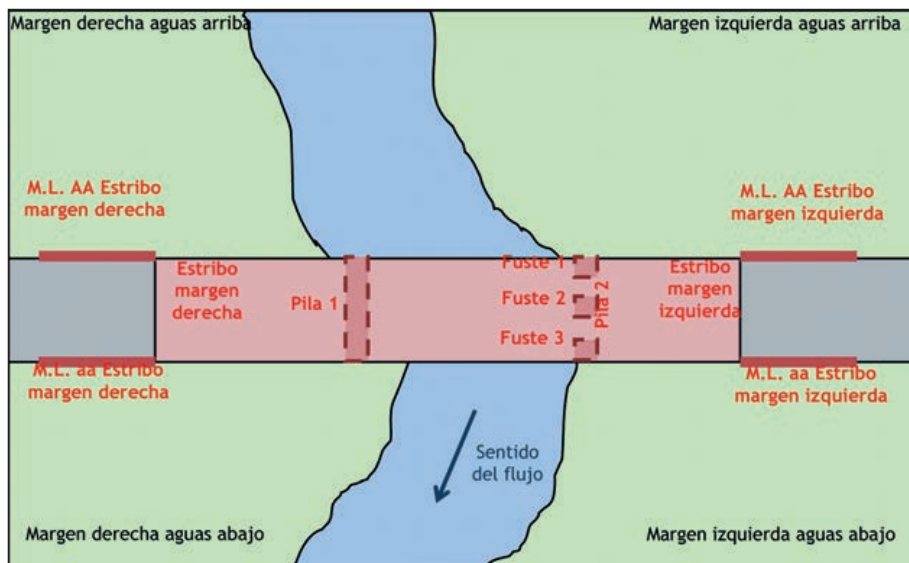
NUMERACIÓN DE ELEMENTOS EN EL PUENTE.
